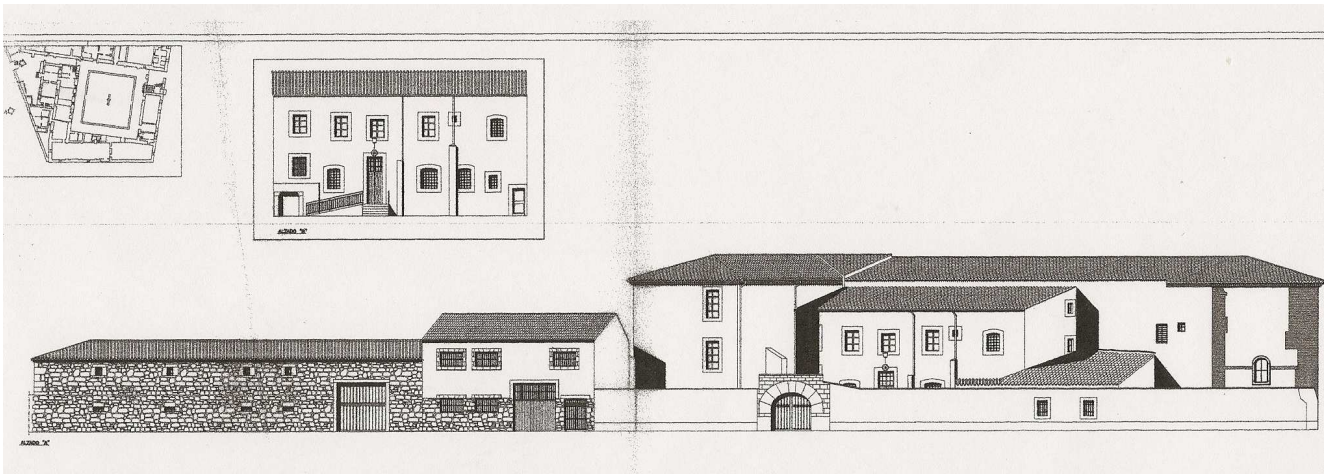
ALZADO DE LA FACHADA ORIENTAL DEL MONASTERIO. Leocadio José Peláez Franco y Miguel Ángel de Lera Losada.
